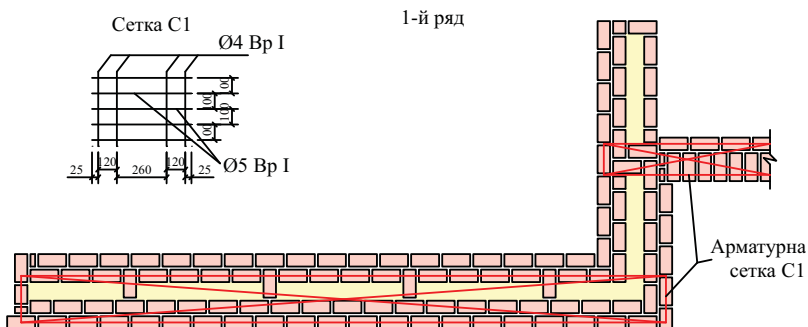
б Фрагмент 1. Армирование сетками
